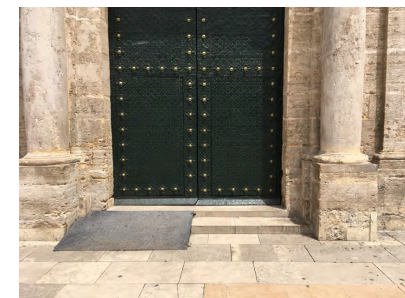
Vista general de las puertas de Acceso 1-2 con los peldaños y la rampa
